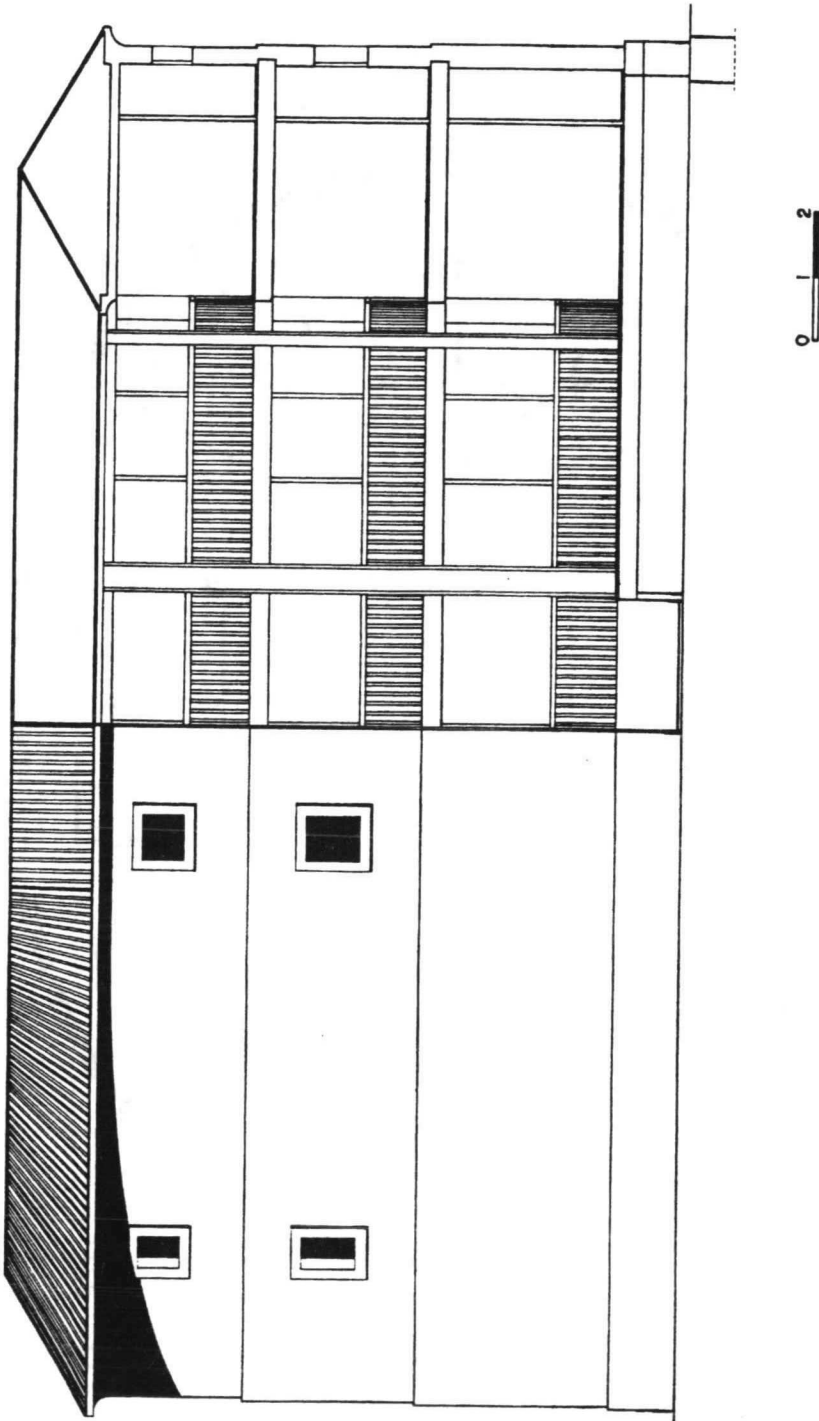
Alzado-sección del patio de comedias de Calaborra. (Reconstrucción ideal).
